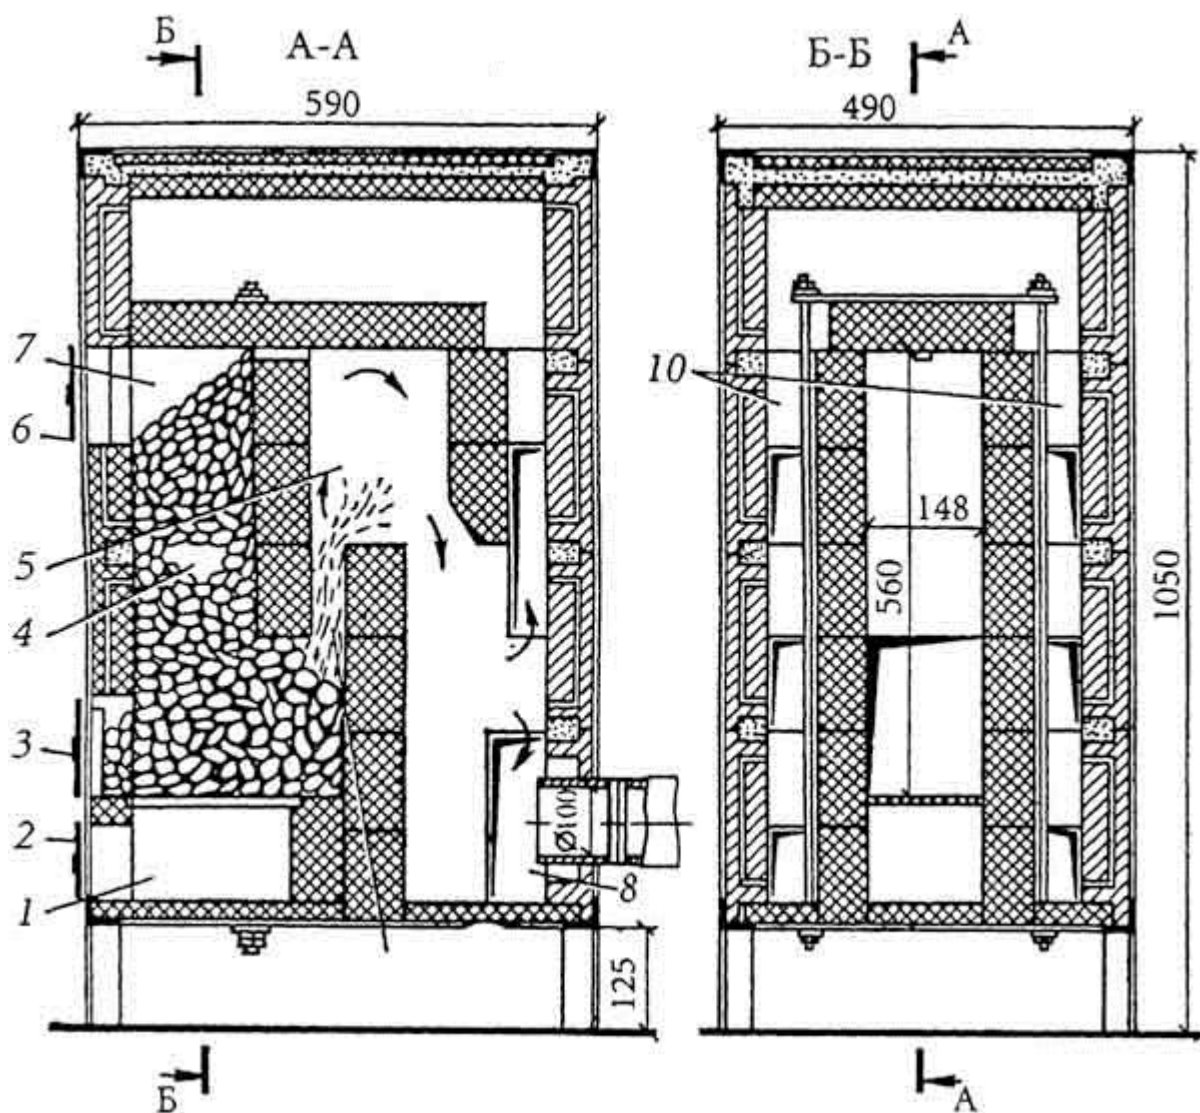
Каркасная отопительная печь длительного горения: 1 - зольник; 2 - поддувальная дверца; 3 - шуровочная дверца; 4 - топливник с колосниковой решеткой; 5 - промежуточная камера; 6 - топочная дверца; 7 - шахта; 8 - коллектор; 9 - средний канал; 10 - боковые каналы
